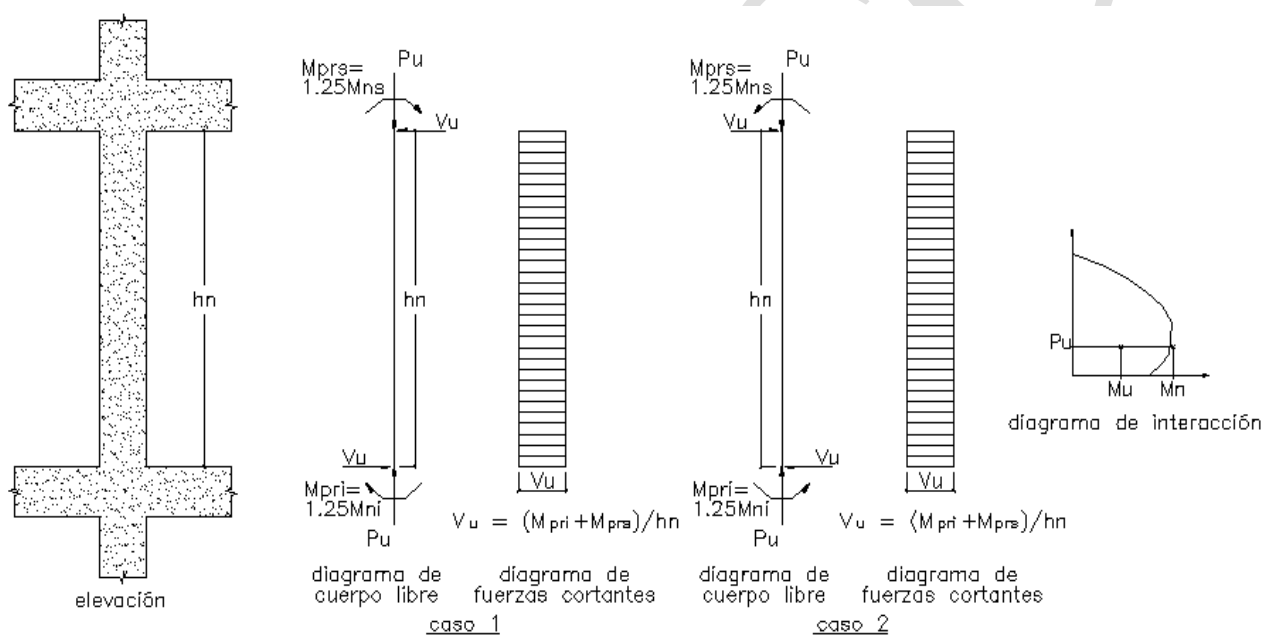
Fuerza cortante de diseño en columnas
